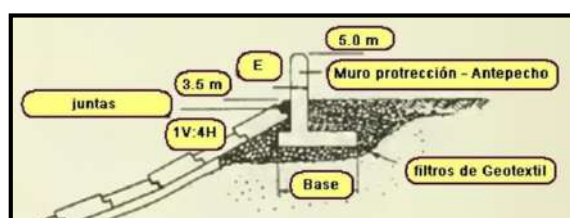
Esquema de protección encuentro de los bloques con el muro.
